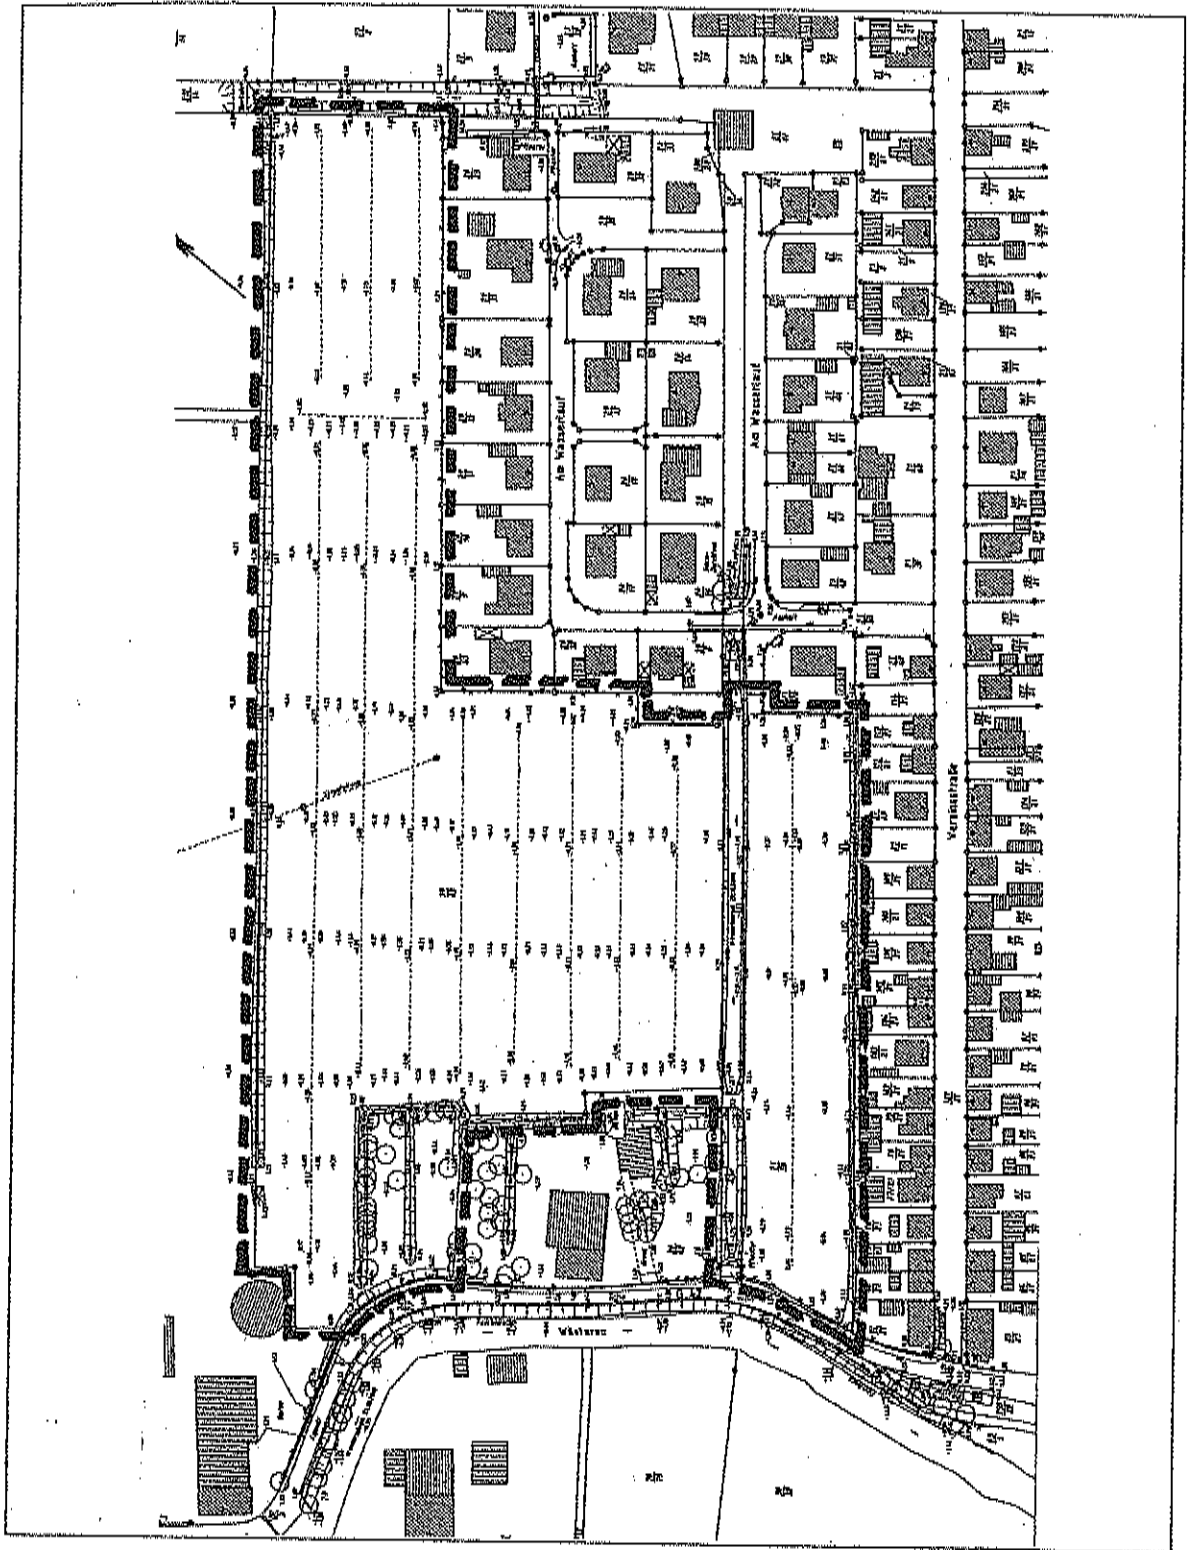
Abgrenzung und Lage des Plangebiets auf Grundlage eines aktuellen Bestandsplanes vom 02.11.2000, unmaßstäblich
